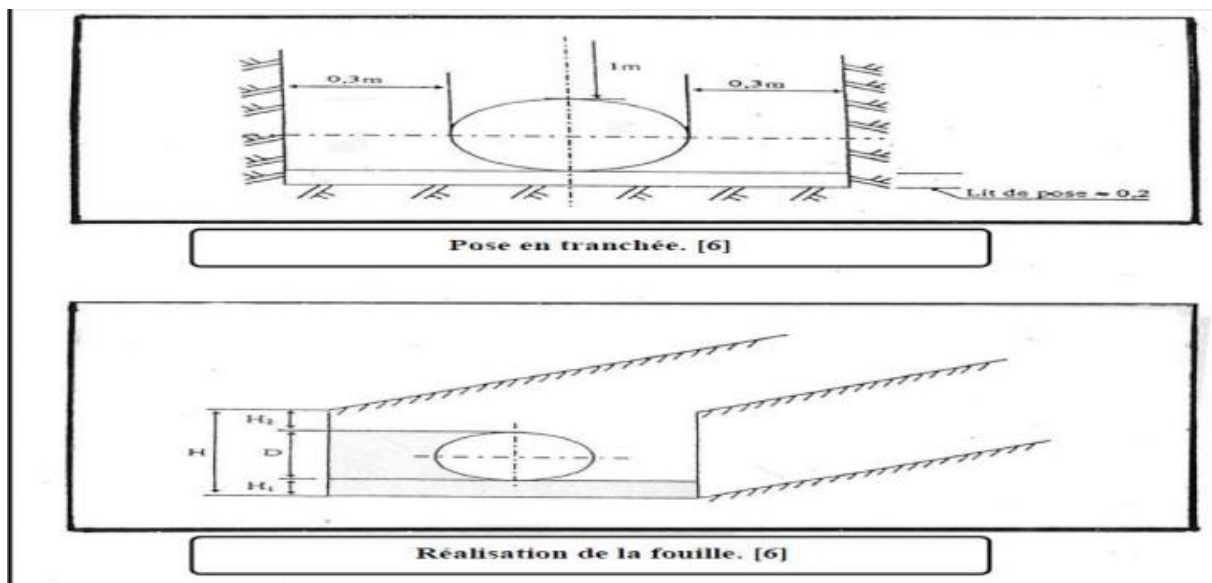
Schéma d'une tranchée avec une conduite circulaire.
